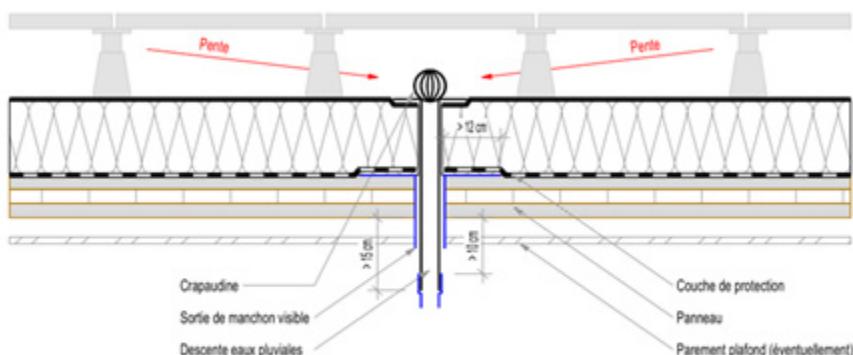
Principe d'évacuation des eaux pluviales en terrasses accessibles aux piétons (DSP)
